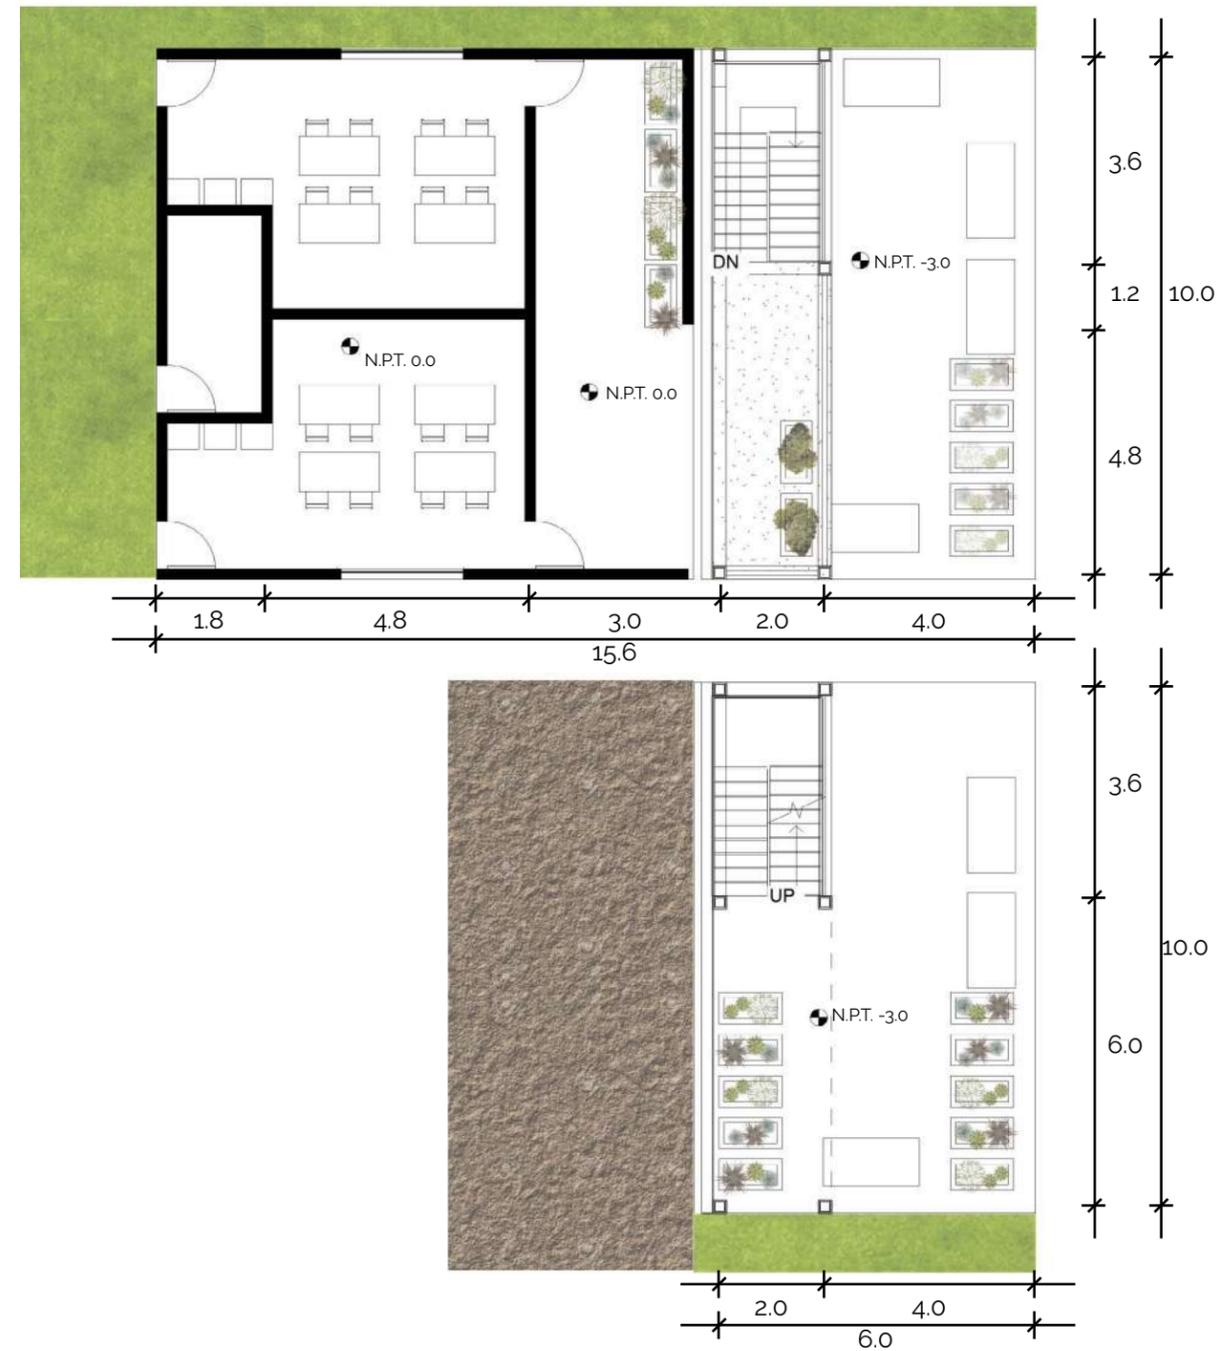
Planta baja del modulo invernadero/taller. Acotaciones en metros.
